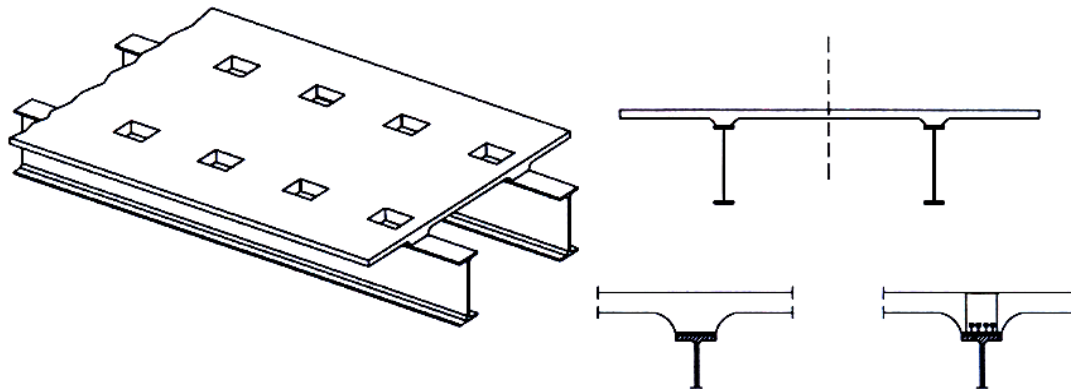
Сборная железобетонная перфорированная плита с вутами над металлическими балками [7]
